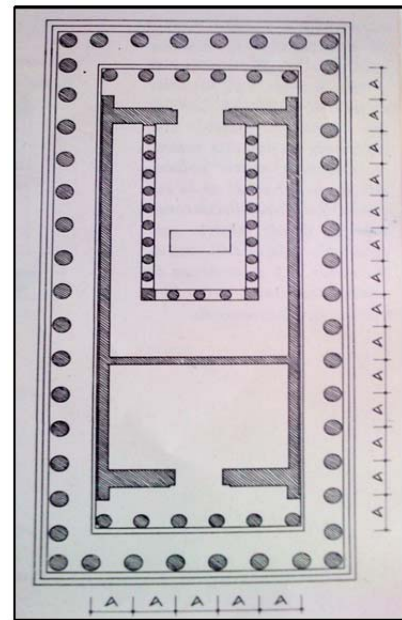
Aplicación del Principio de Repetición en la planta arquitectónica del Partenón de Atenas.¹²
